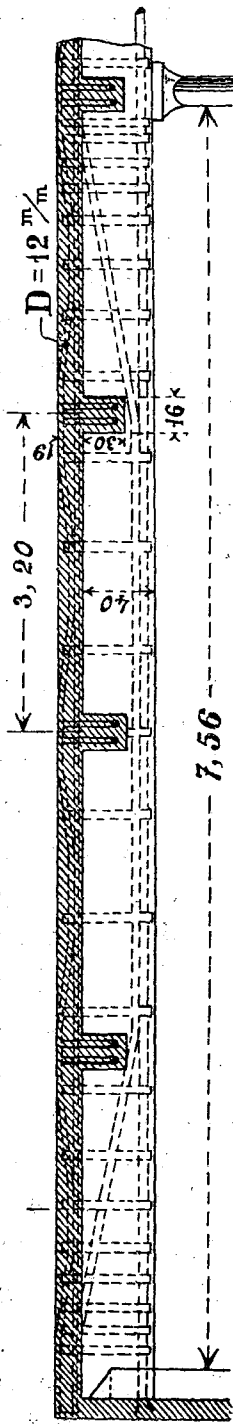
Suelo de hormigón armado del «Bon Marché» de París; vigas maestras y sección transversal de las viguetas.
